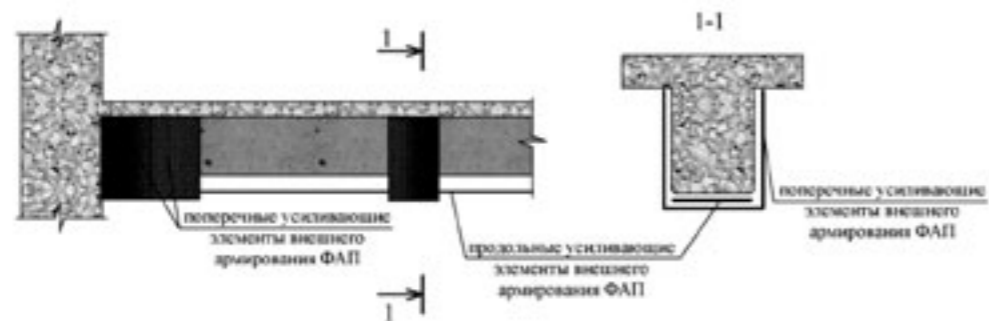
Усиление балки перекрытия внешним армированием ФАП
